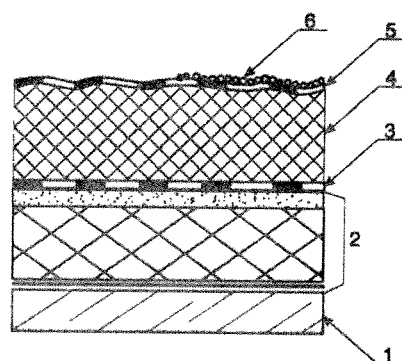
Конструкция с утеплителем из ППУ при ремонте старой кровли:
